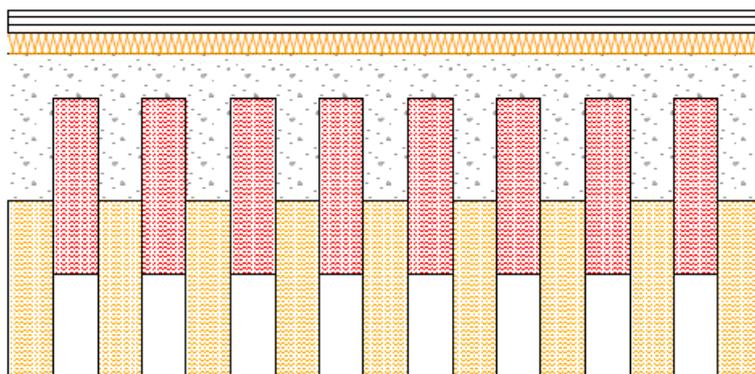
Coupe type d'une D-Dalle® avec traitement du sol en couches dure-mou-dure, permettant l'absorption et la résilience du bruit d'impact
